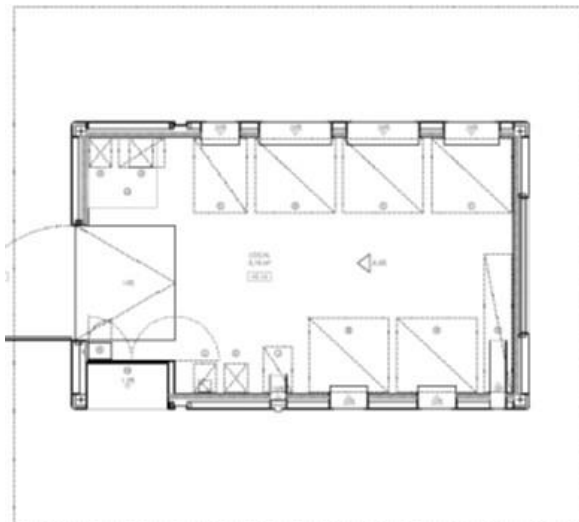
Plano en planta del Ecopunto. Fuente: LIPASAM, 2022.
